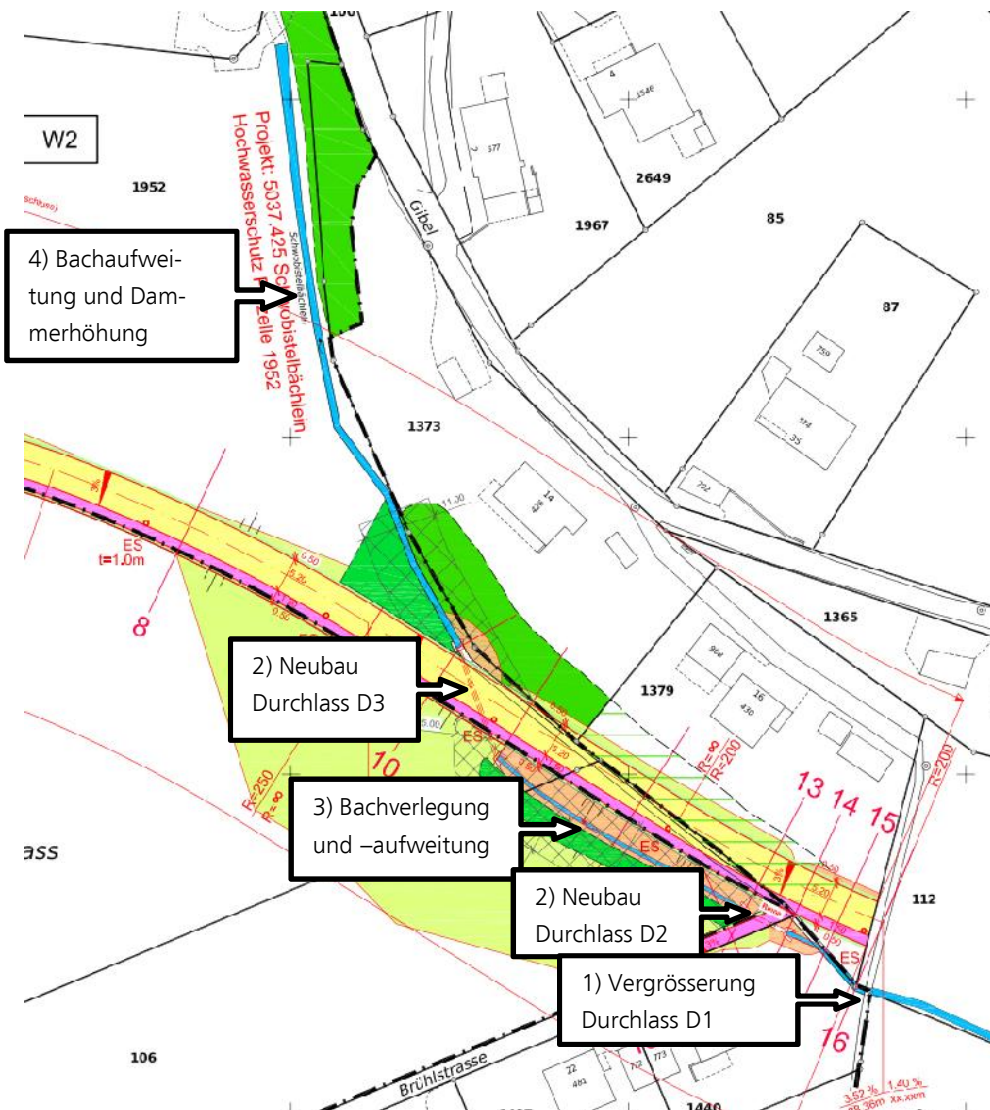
Bauliche Änderungen am Schwobistelbächlein
